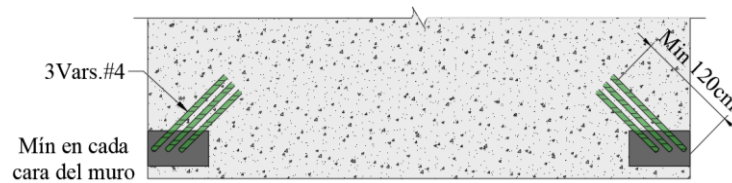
b - Refuerzos diagonales en la zona de conexión con la cimentación
